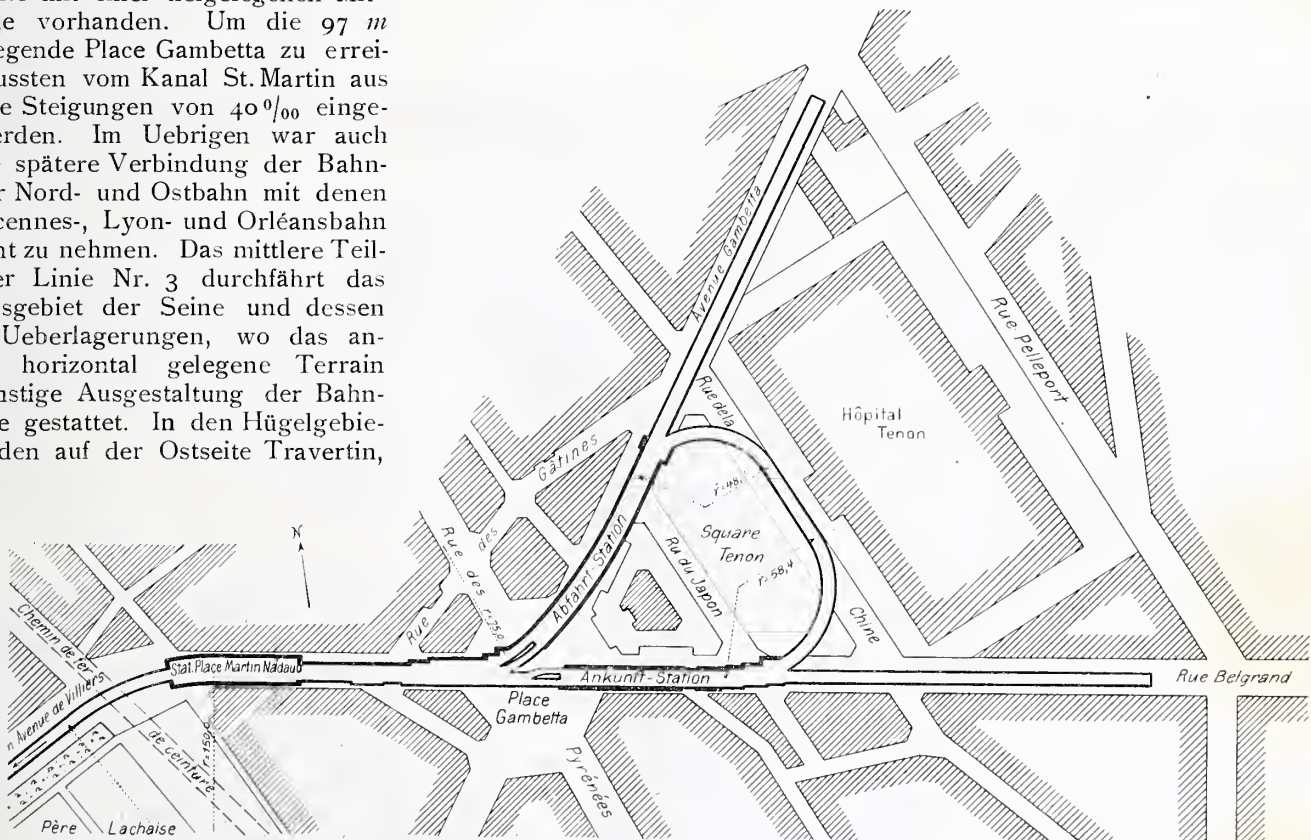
Endstation unter der Place Gambetta. — Lageplan. — Masstab 1 : 5000.
